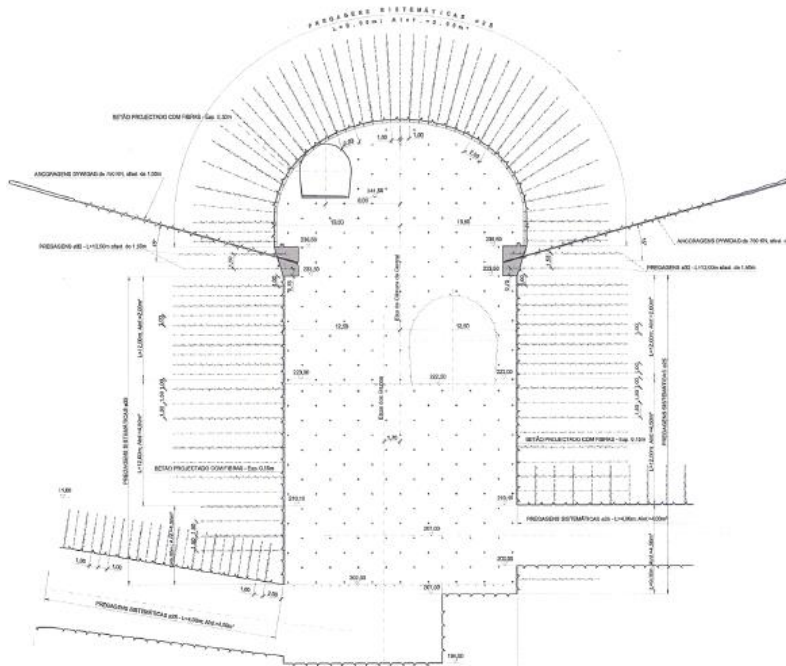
Corte transversal da caverna da central de Venda Nova III; [3]
